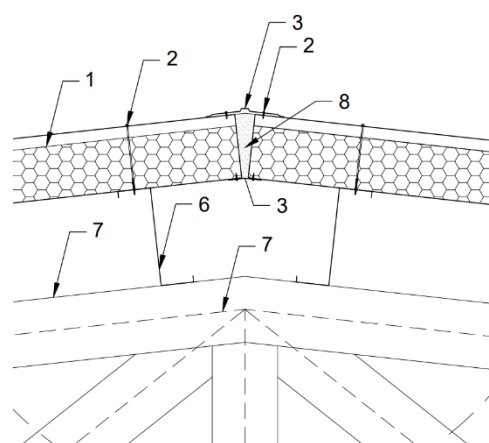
Przekrój poprzeczny płyty warstwowej dachowej
